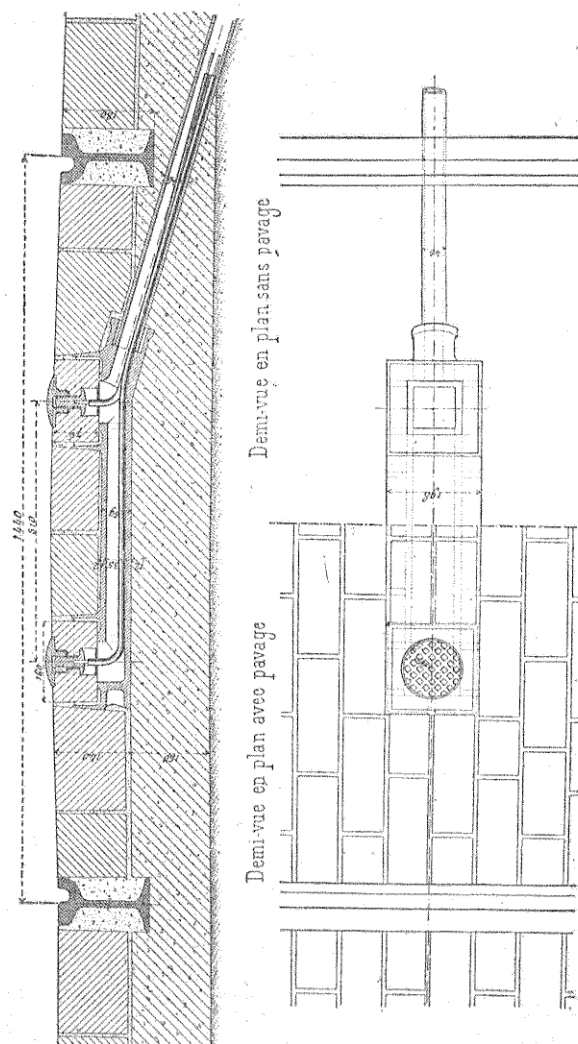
et 760. — Coupe et plan d'une voie de tramways sur une chaussée.
